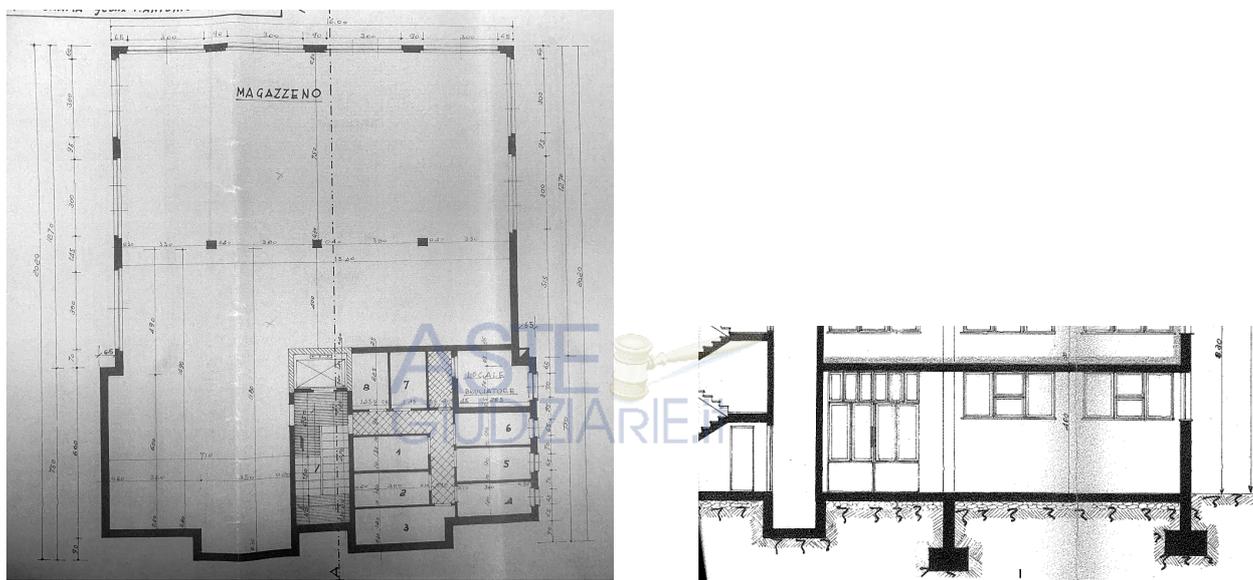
Estratto di Licenza Edilizia n.341/1971- Planimetria piano seminterrato e sezione
